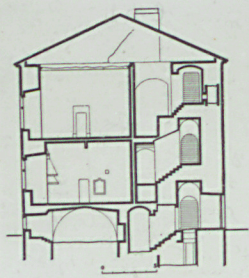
Piątków, zamek. Przekrój poprzeczny (str. 238).
